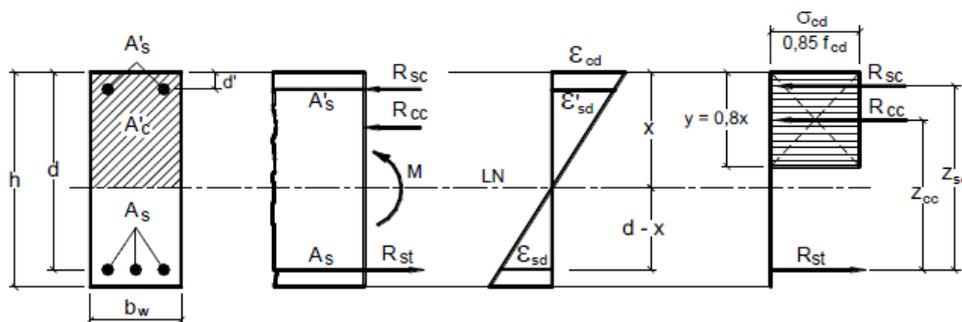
Tensões e deformações em seção viga retangular duplamente armada. Fonte: BASTOS (2015)
